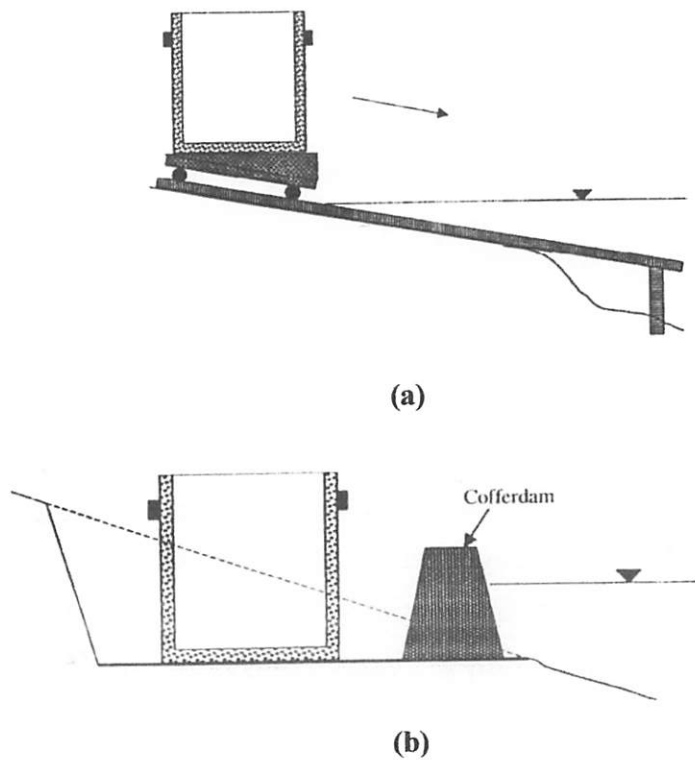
Proses Fondasi Sumuran dengan Casing Ditinggal
